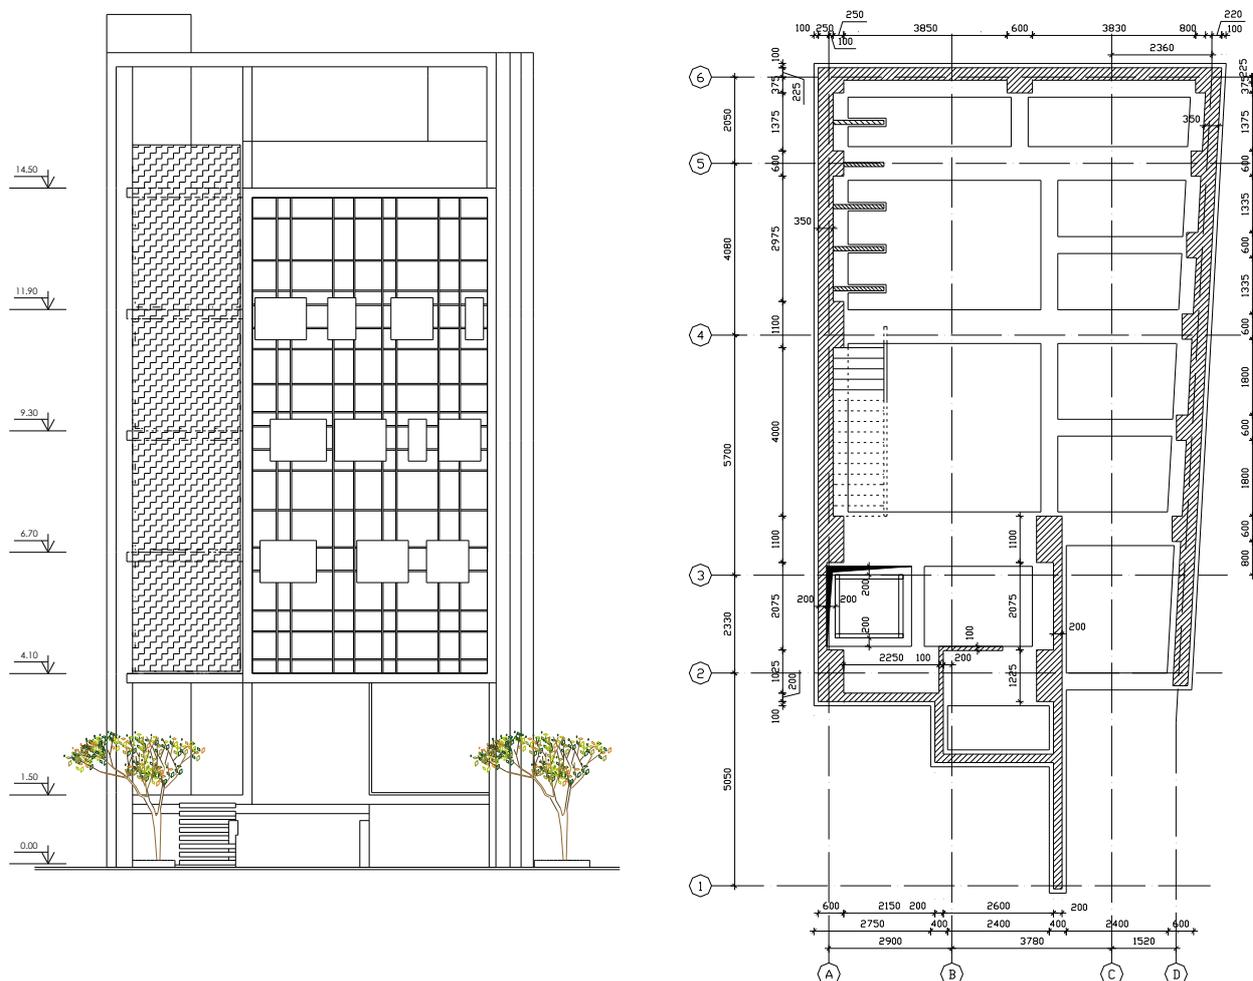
Главный фасад жилого здания по ул. Чулло в г. Арекипа (Перу) и план несущих конструкций его подвального этажа, где размещена система сейсмоизоляции (на плане показаны также фундаментные ленты)
